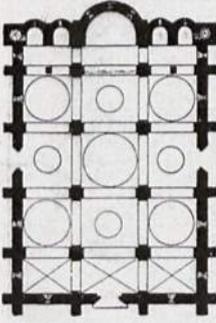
Schematischer Grundriß einer russischen Kirche. Nach Viollet-le-Duc.
